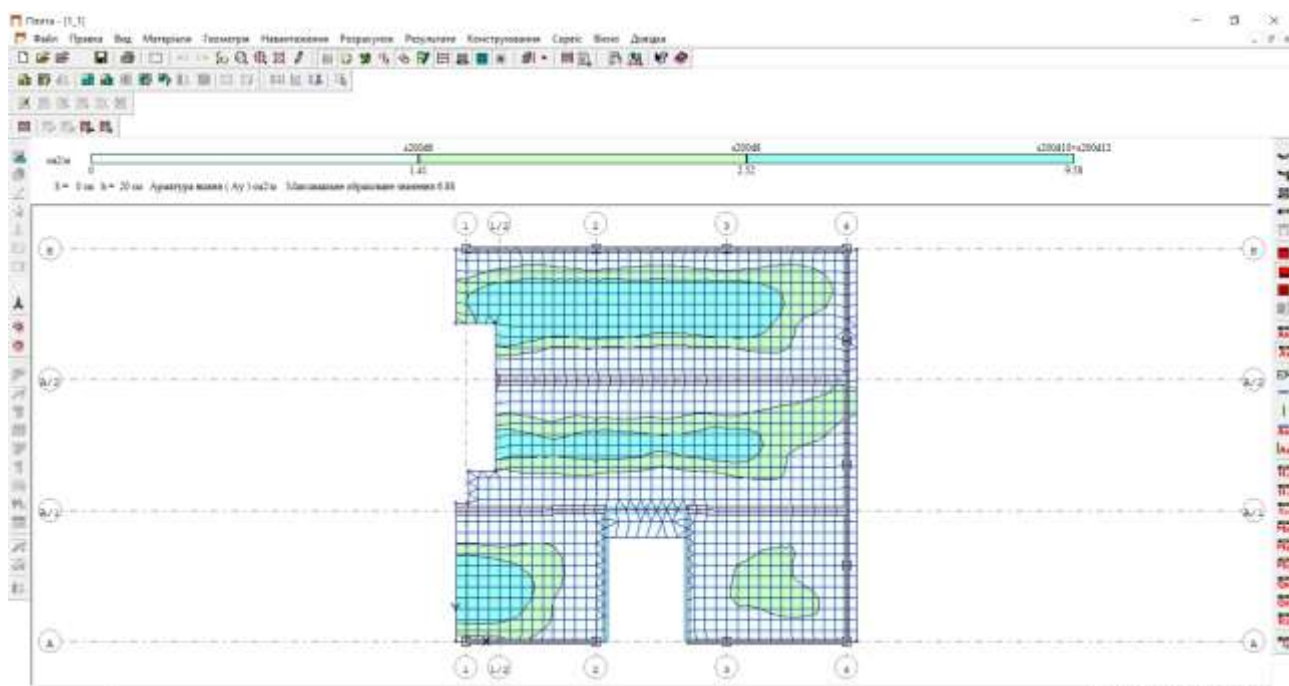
Підбір площі армування A_u по низу у проектованій плиті перекриття над першим поверхом
